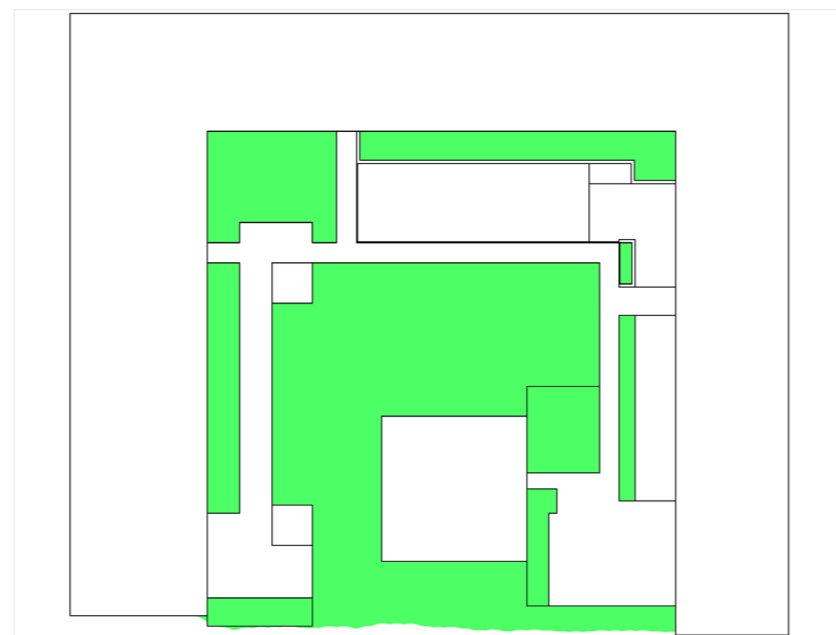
Plan over plan og bygningsetatens kjeller.
